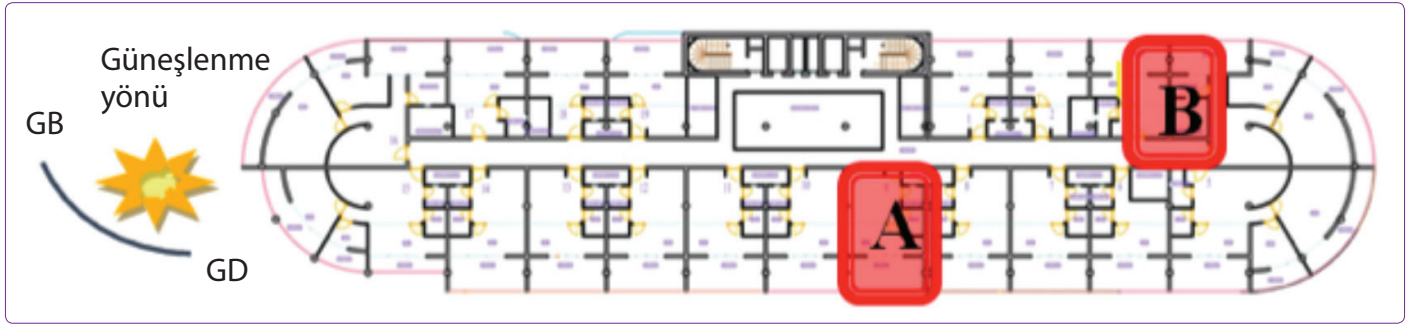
Ulusoy Plaza vaziyet planı.²¹
